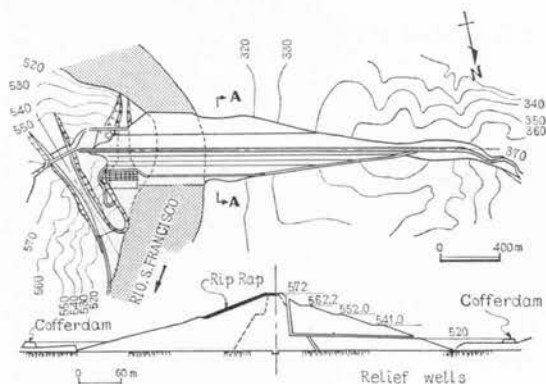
トレスマリアスダム一般平面図およびアースダム断面図
